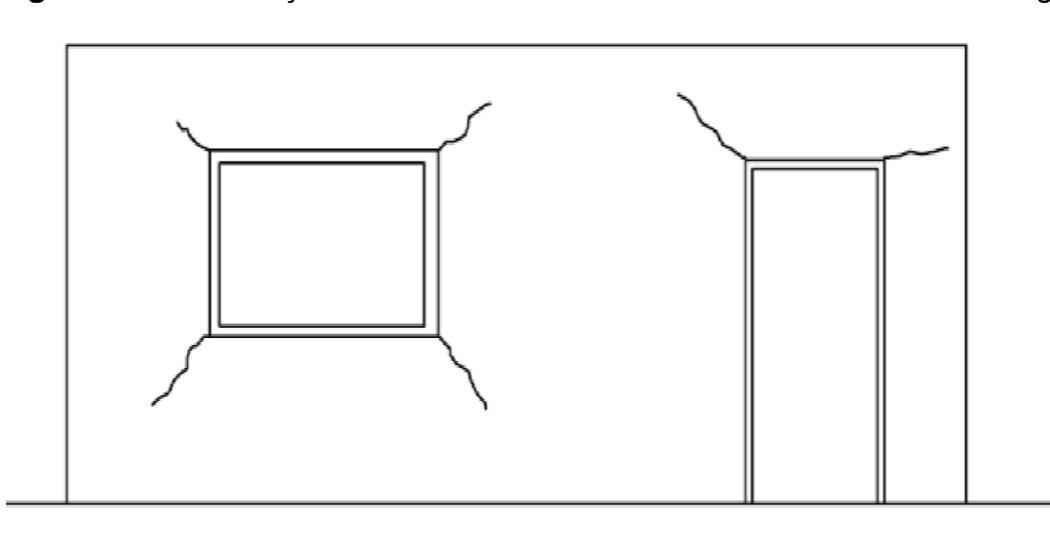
Fissuras localizadas na edificação da Fazenda Experimental da UFGD
